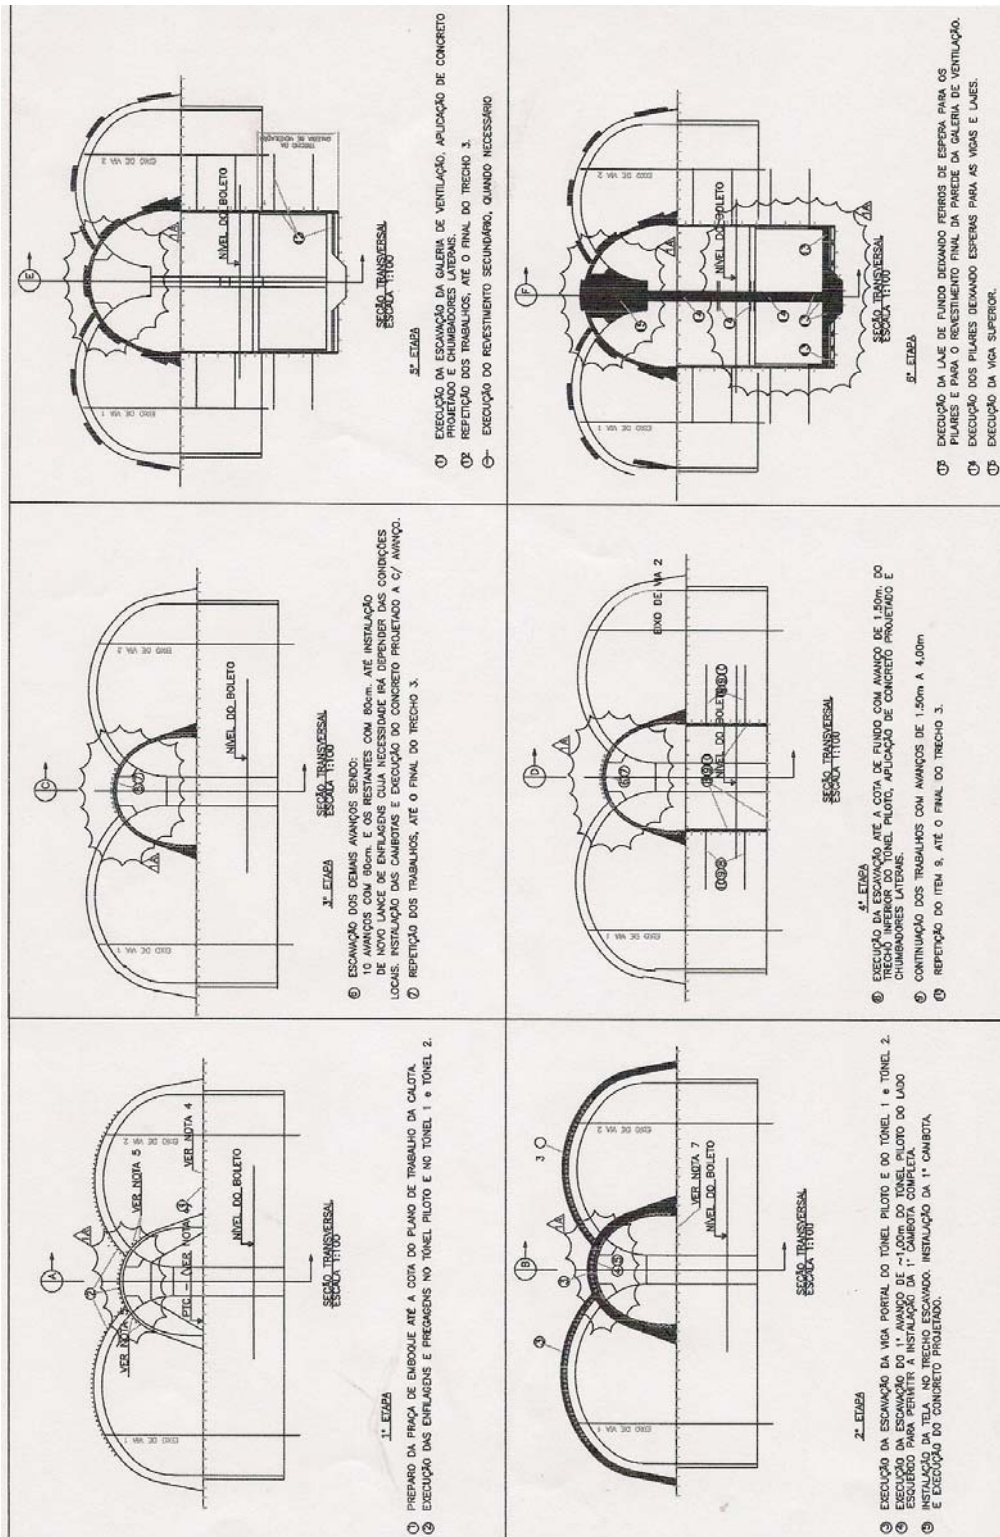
Processo construtivo do túnel piloto (modificado – Metrosal, 2001i)
